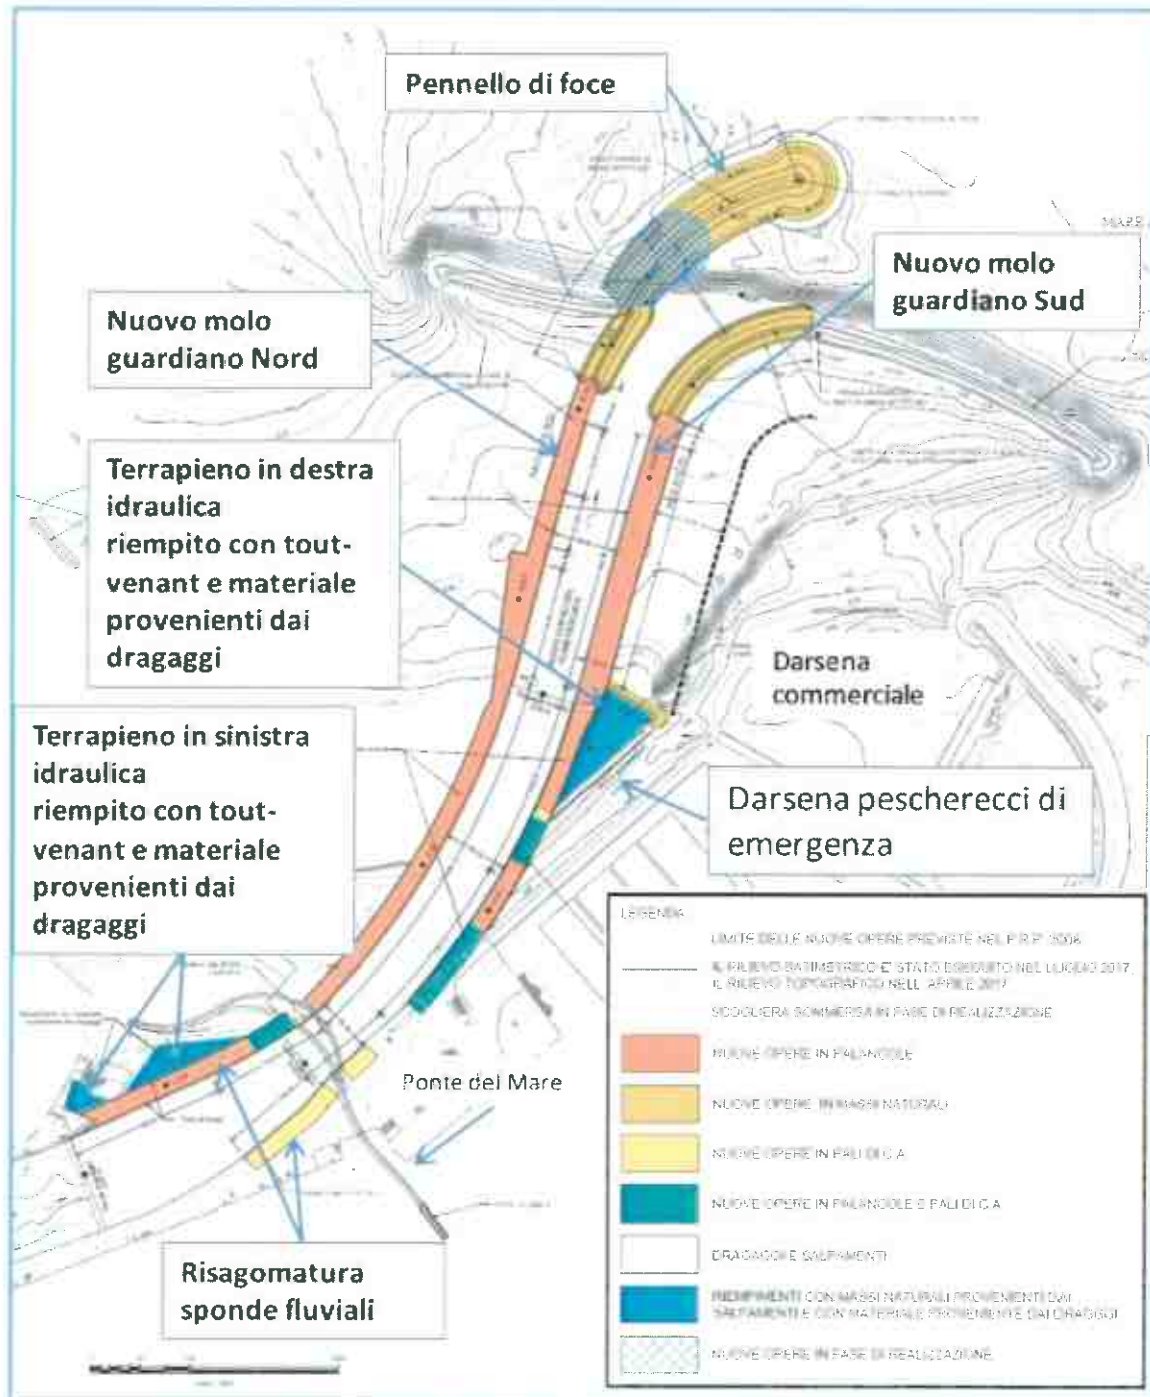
PLANIMETRIA DELLE OPERE IN PROGETTO
